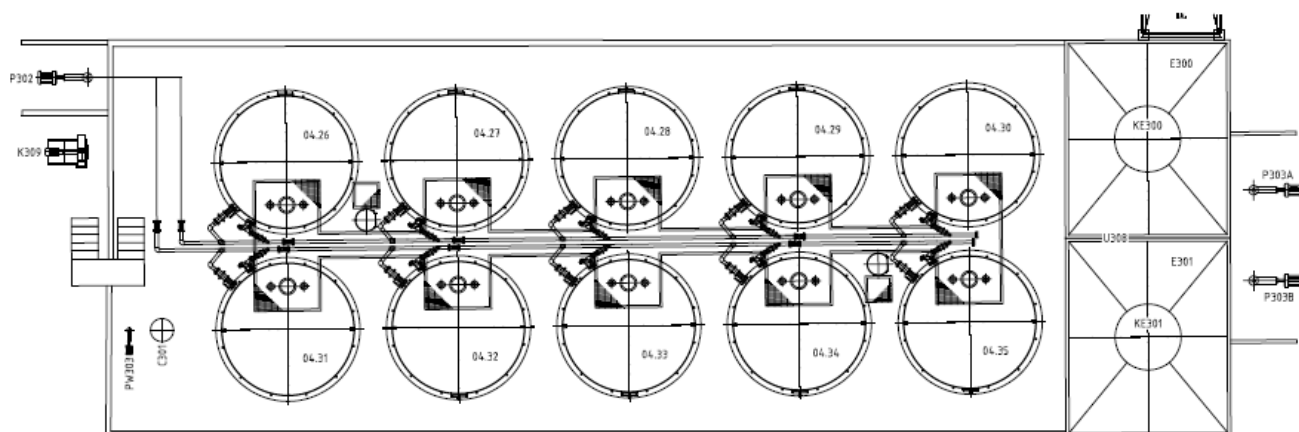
Planimetria del bacino di stoccaggio dei serbatoi di acido cloridrico.
